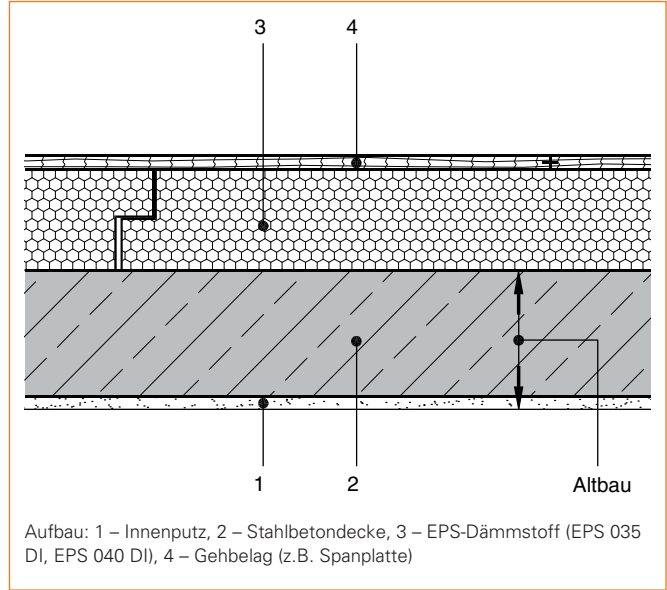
Sanierungsvariante: Betondecke – oberste Geschossdecke
